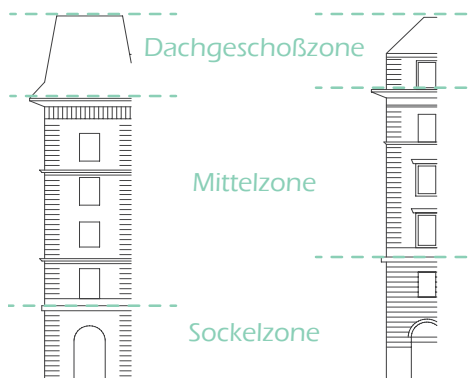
Foto Zonierung Rathausstraße - Doblhoffgasse (l.)
